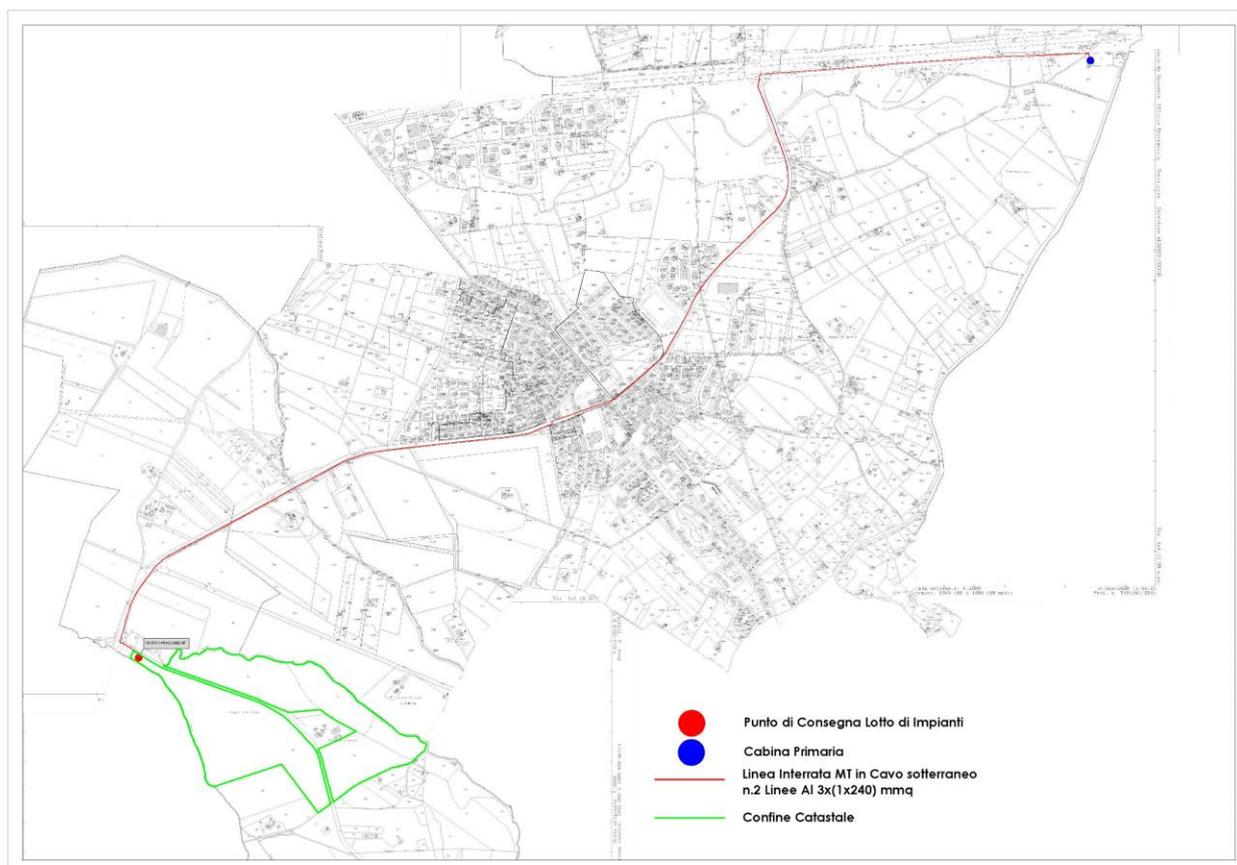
Area Interessata dall'Intervento (Impianto FV e Cavidotto) su Stralcio Catastale
